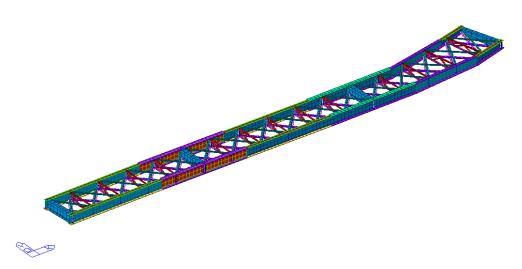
Vista 3D della carpenteria metallica (Rampa C)
